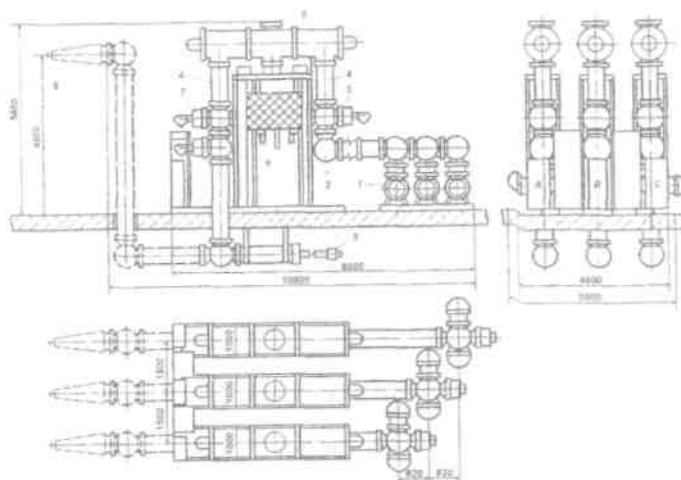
, КРУЭ-220 кВ. Однополюсная ячейка с одной Системой сборных шин: 1 — сборная шина; 2 — шинный распределитель; 3, 7- заземлители; 4 — трансформаторы тока; 5 — выключатель; 6 — линейный разъединитель; 8 — воздушные вводы; 9 — кабельные вводы
